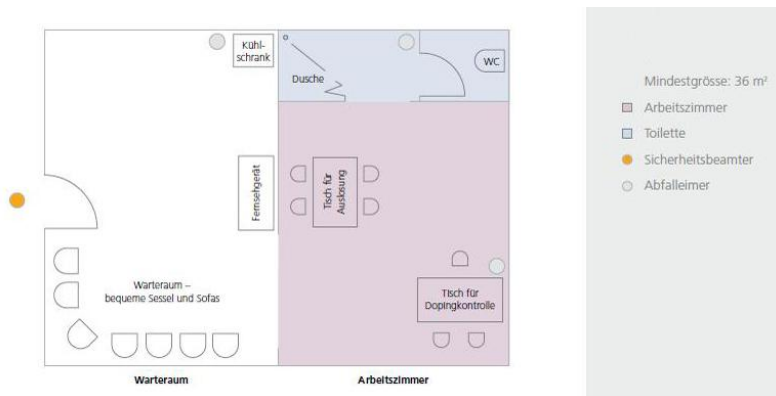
Grundriss eines Dopingkontrollraumes
